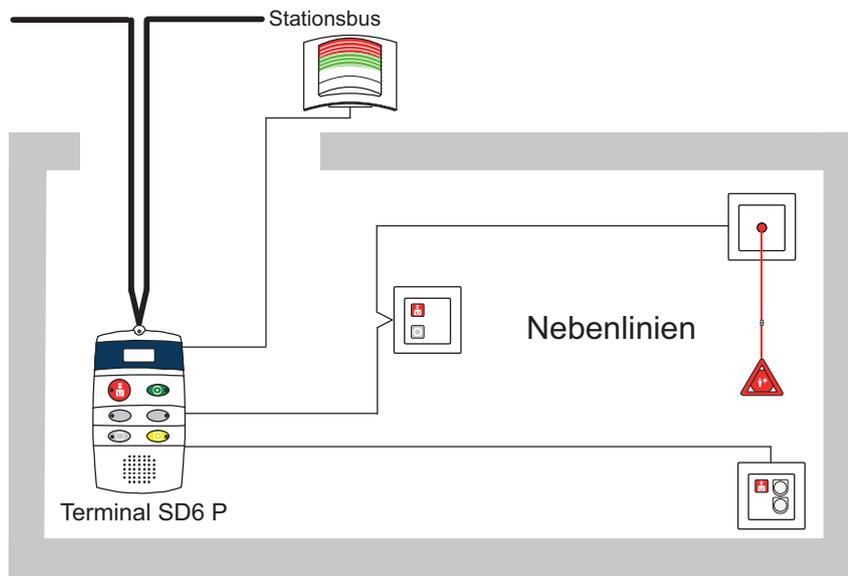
Zimmer (außer Zimmer mit Steuermodul ZLB)
